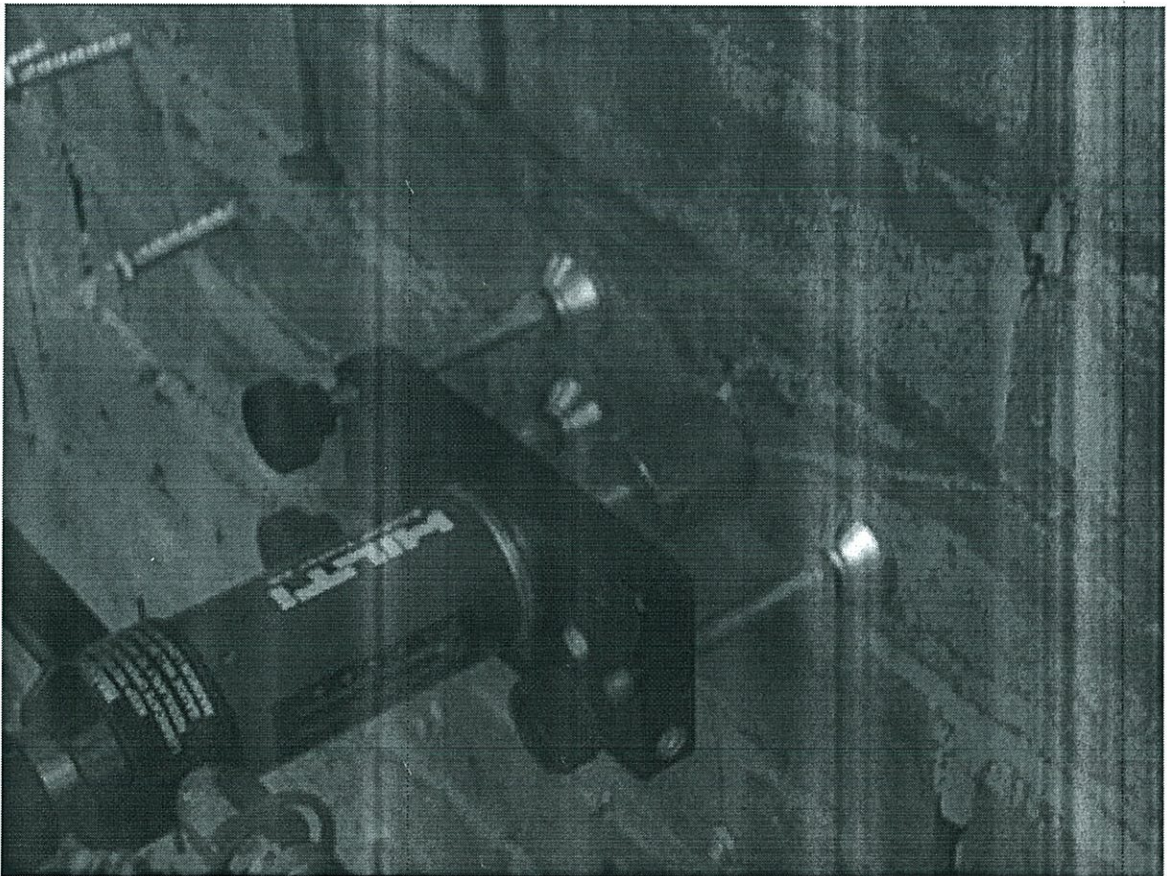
Испытание анкера марки HRD, закреплённого в вертикальный растворный шов кладки из вибропрессованного бетонного кирпича
